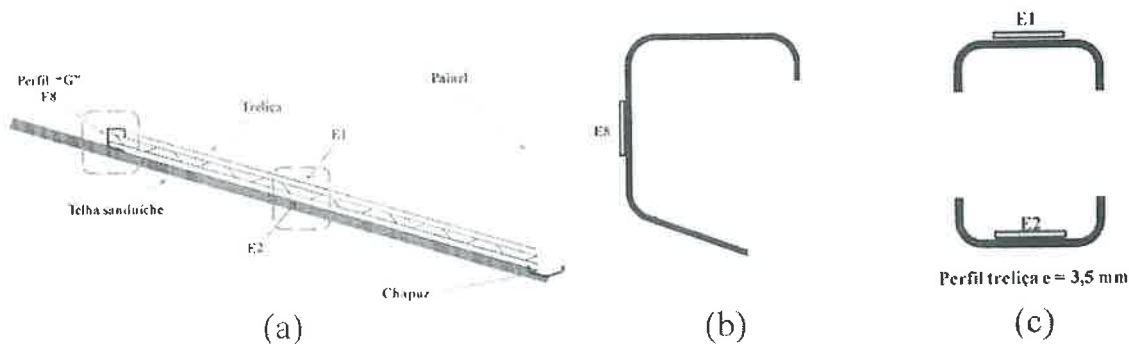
(a) Localização dos extensômetros E₁; E₂ na treliça T₂ e do E₈ no perfil “G”; (b) detalhe da posição do extensômetro E₈ no perfil “G”; (c) detalhe da posição dos extensômetros na treliça central (T₂).
